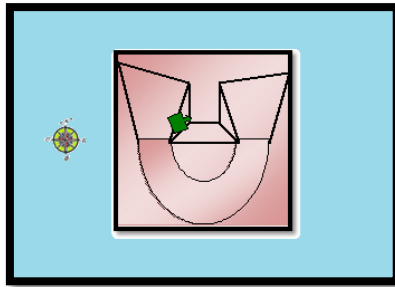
Planta de la torre de la Galera. Sin escala. Elaboración propia.
